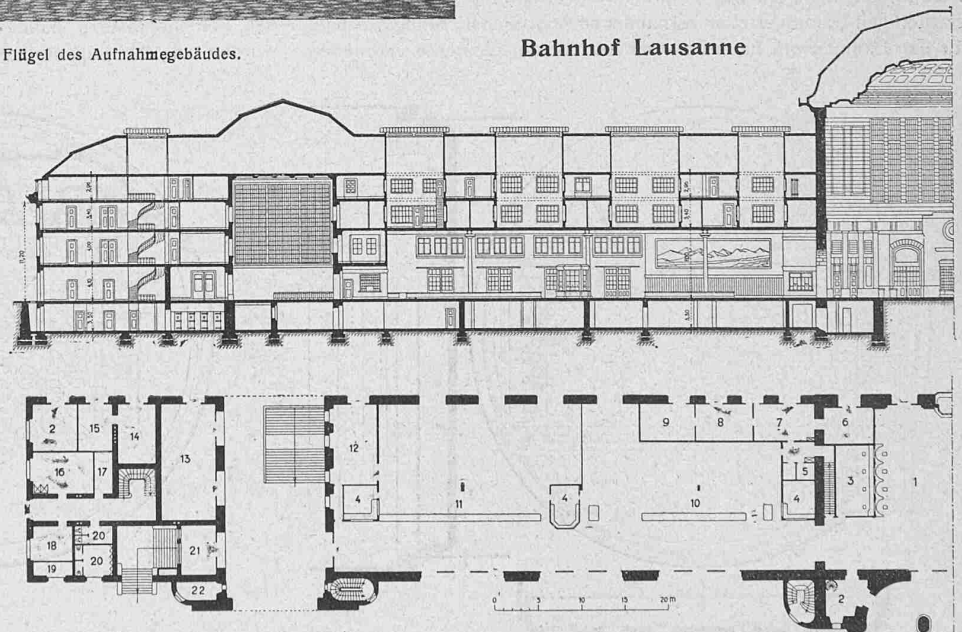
und 4. Grundriss und Längsschnitt der östlichen Gebäudehälfte. — 1:800. — (Legende S. 177.)
